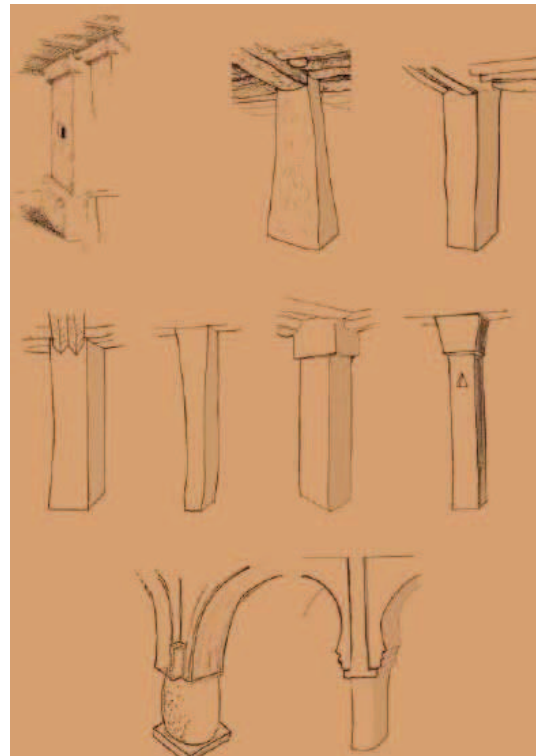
Inventaire des piliers et chapiteaux du ksar.
